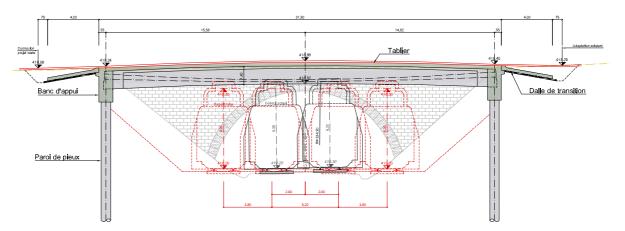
coupe longitudinale du nouveau PS de la Redoute
